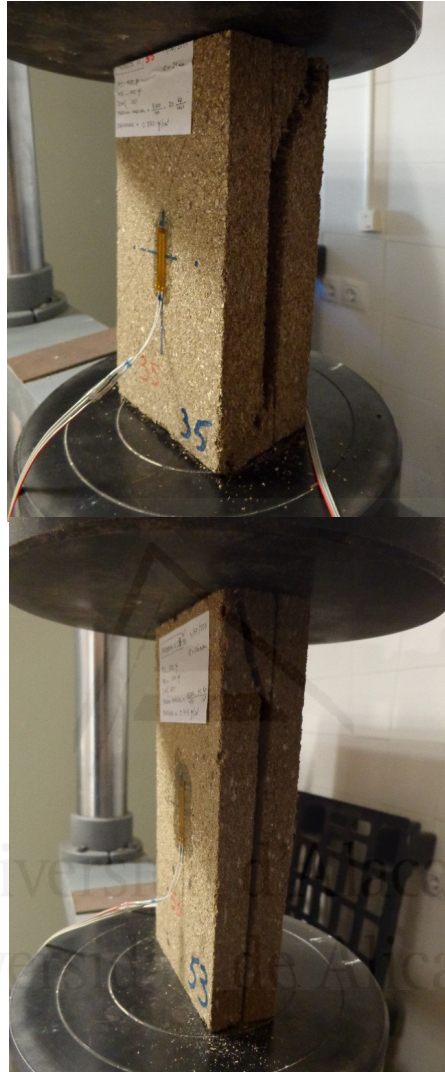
Tipo de rotura 1: fallo parcial en los apoyos.
